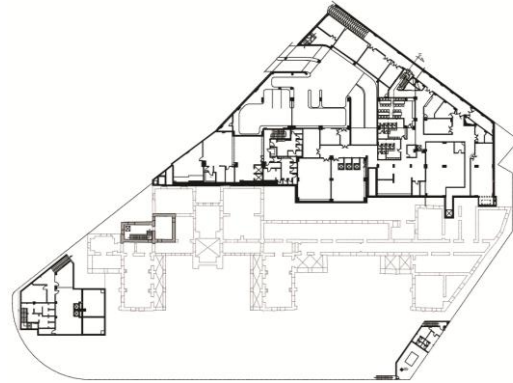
المسقط الأفقي للطابق الأرضي.
